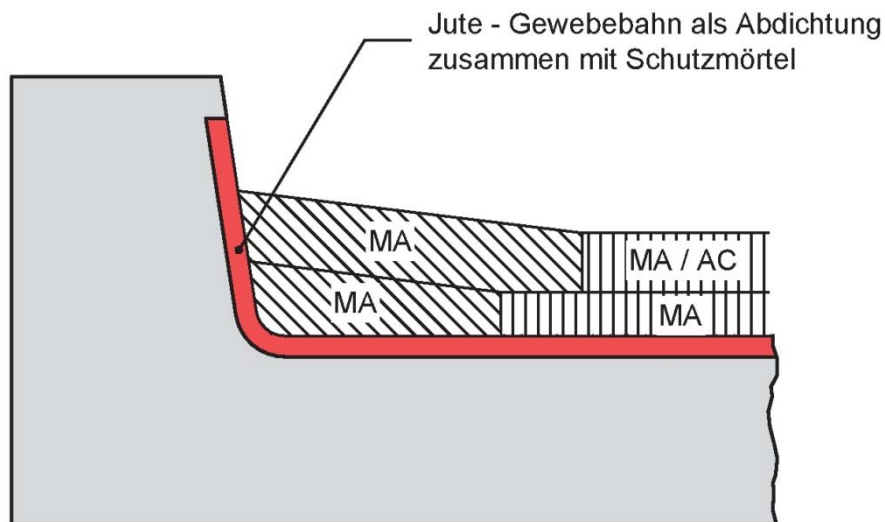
Anschluss mit Bitumen-Dichtungsbahn mit Jute-Trägereinlage
